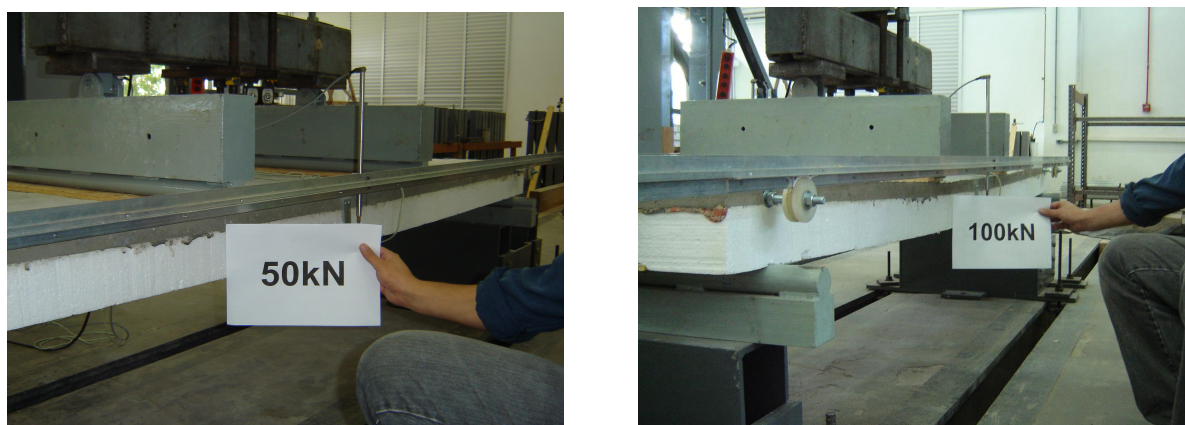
Ruptura da laje mista 01, na seção e na face inferior da capa de concreto, ao longo do comprimento da laje entre o apoio e o cutelo de carga.
